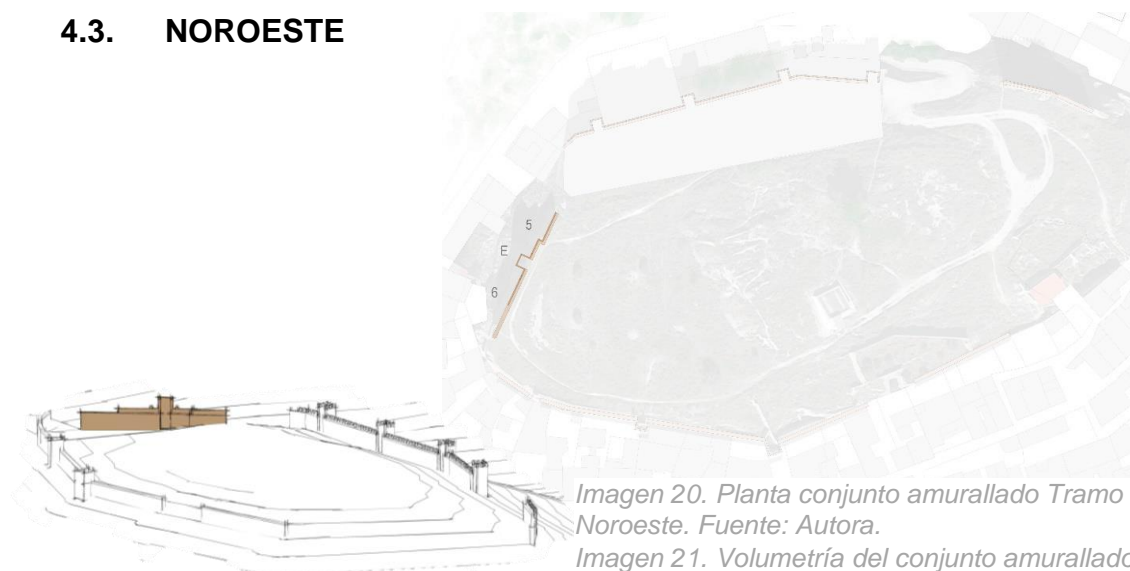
Planta conjunto amurallado Tramo Noroeste. Fuente: Autora.
